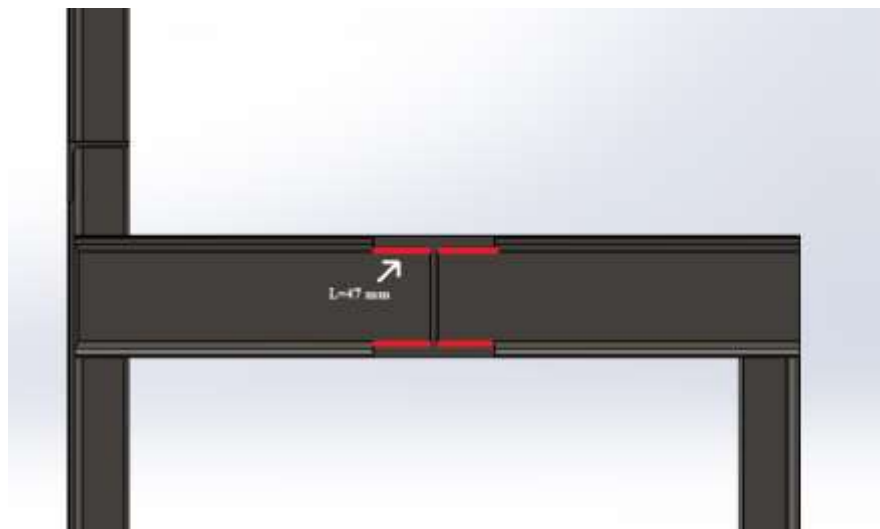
Longitud de la soldadura Perfil de la viga HEB 100
